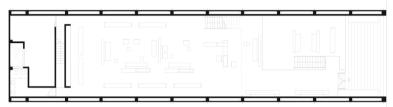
Planta Baja: zapatería California, La Habana, Cuba. 1951.
